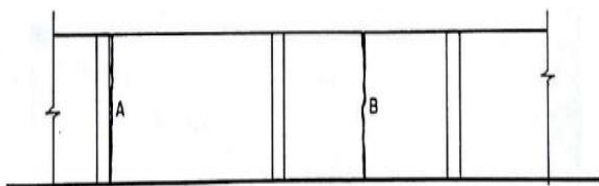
Fissuração por movimentação térmica da laje de cobertura sobre paredes autoportantes.
